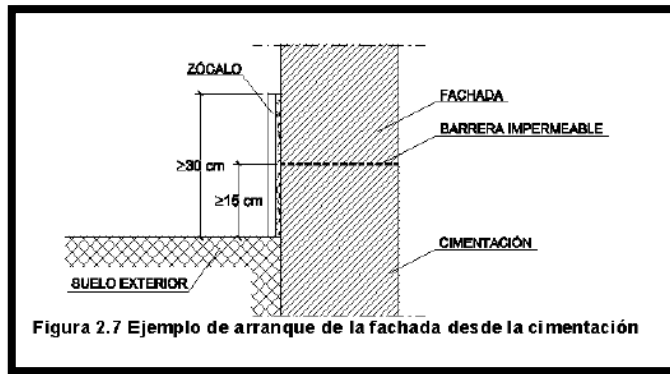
Ejemplo de arranque de la fachada desde la cimentación
